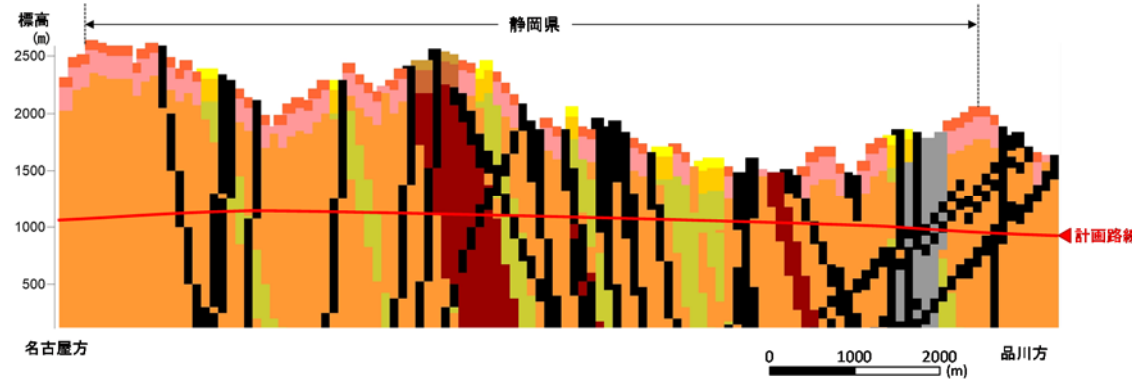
J R東海モデル 地質断面図(静岡県付近)
